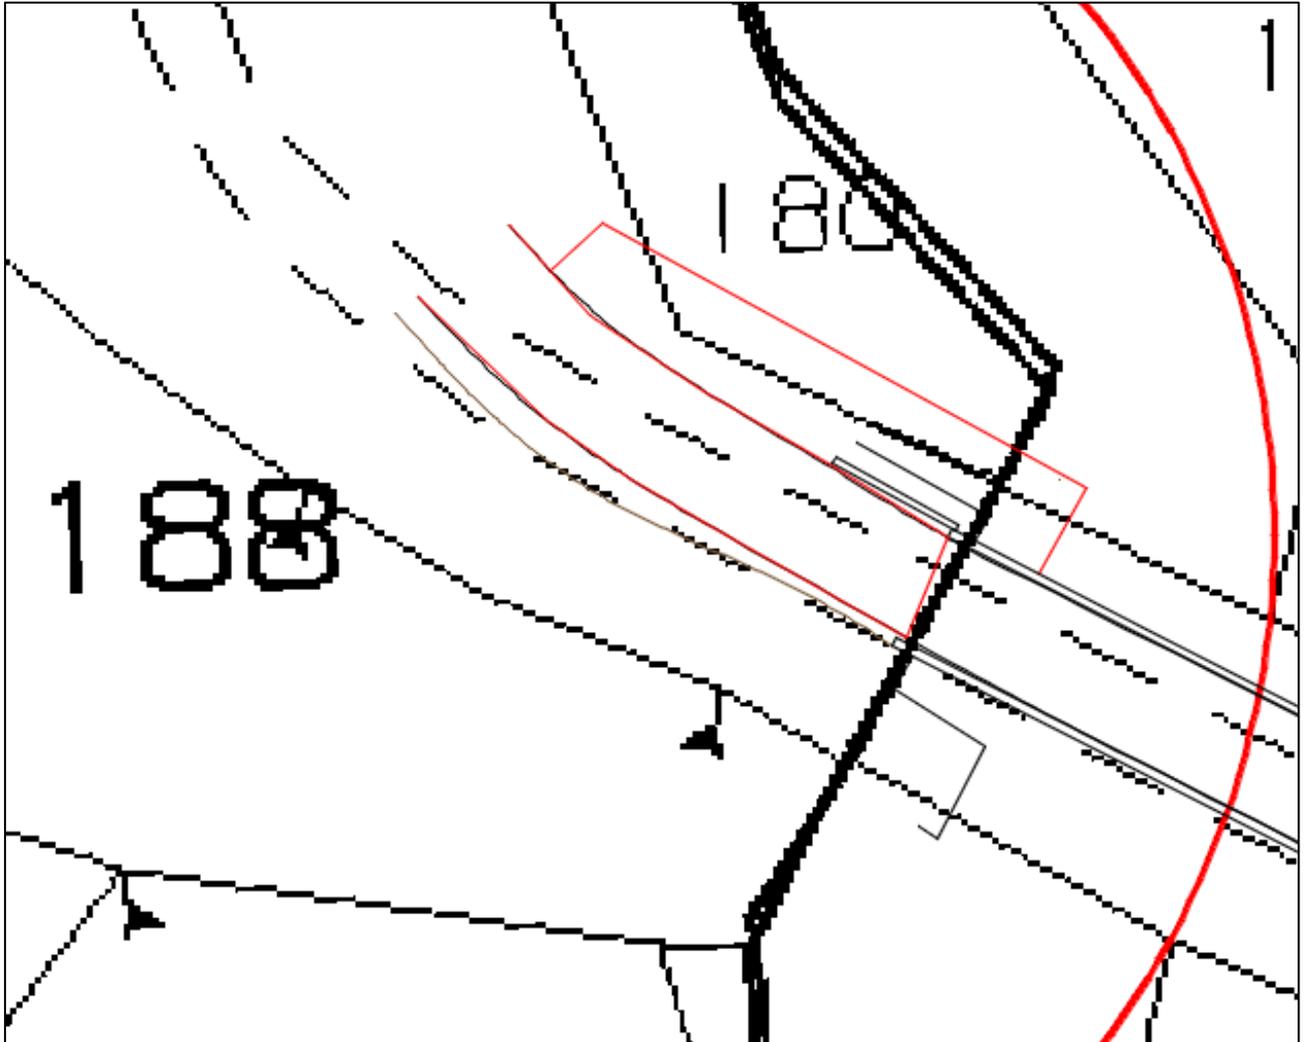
Area pista di cantiere per trave di correa e tiranti – Intervento 1
